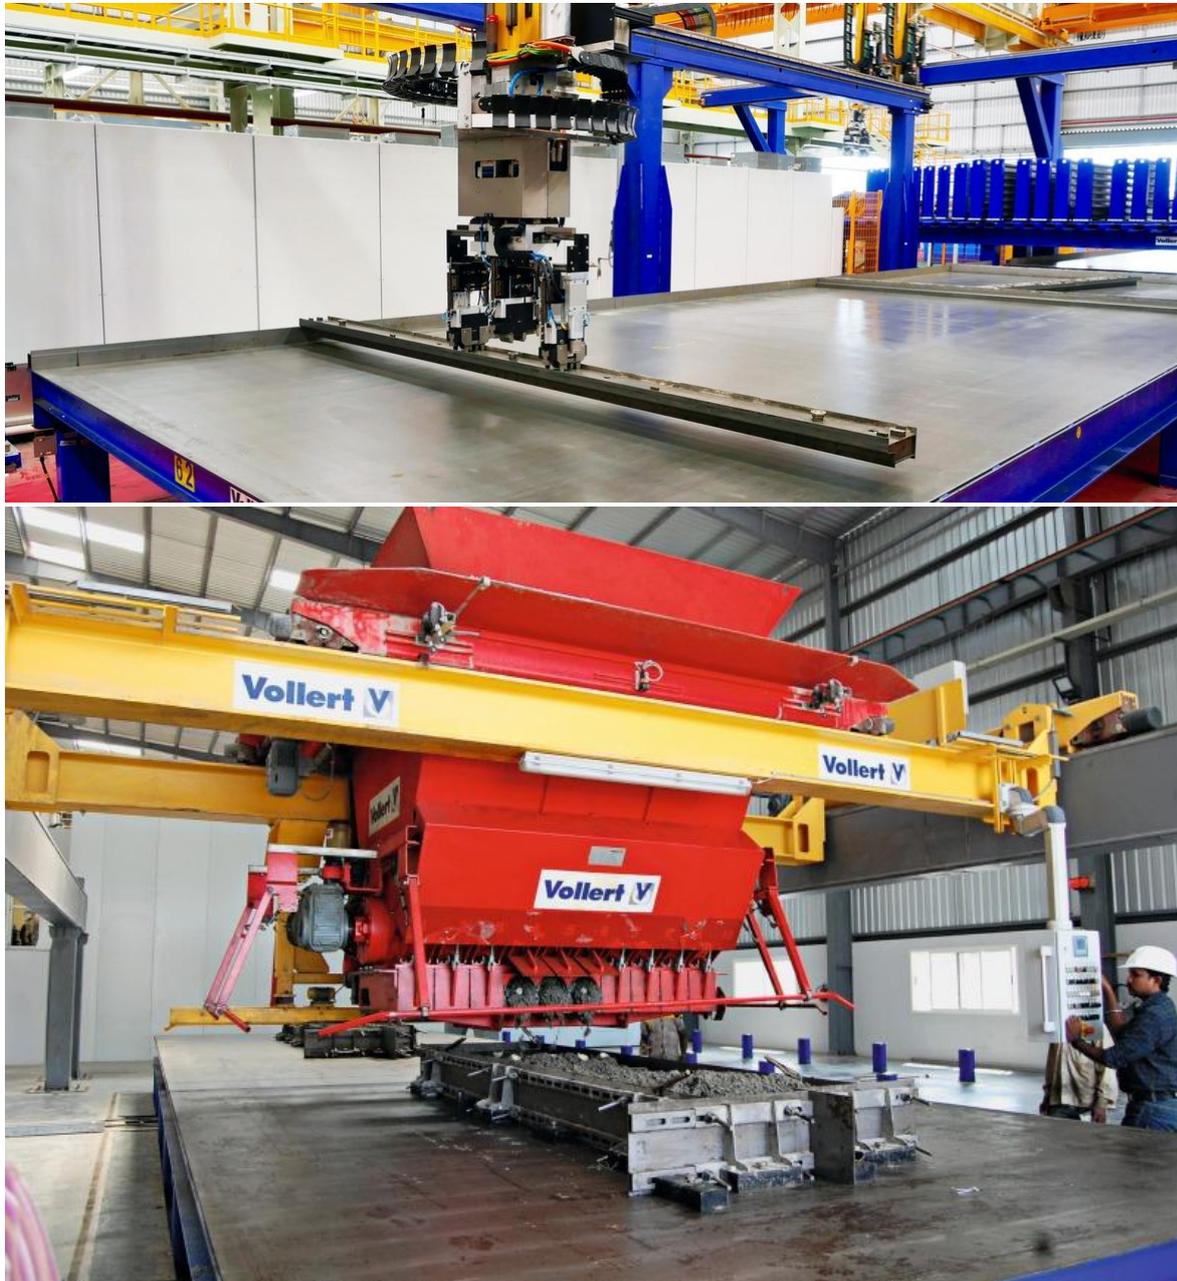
Sistema automatizado de construcción de muros prefabricados de hormigón. Arriba: sistema de disposición de moldajes automático. Abajo: sistema guiado computacionalmente para el vertido de hormigón. (fuente: vollert.de)
